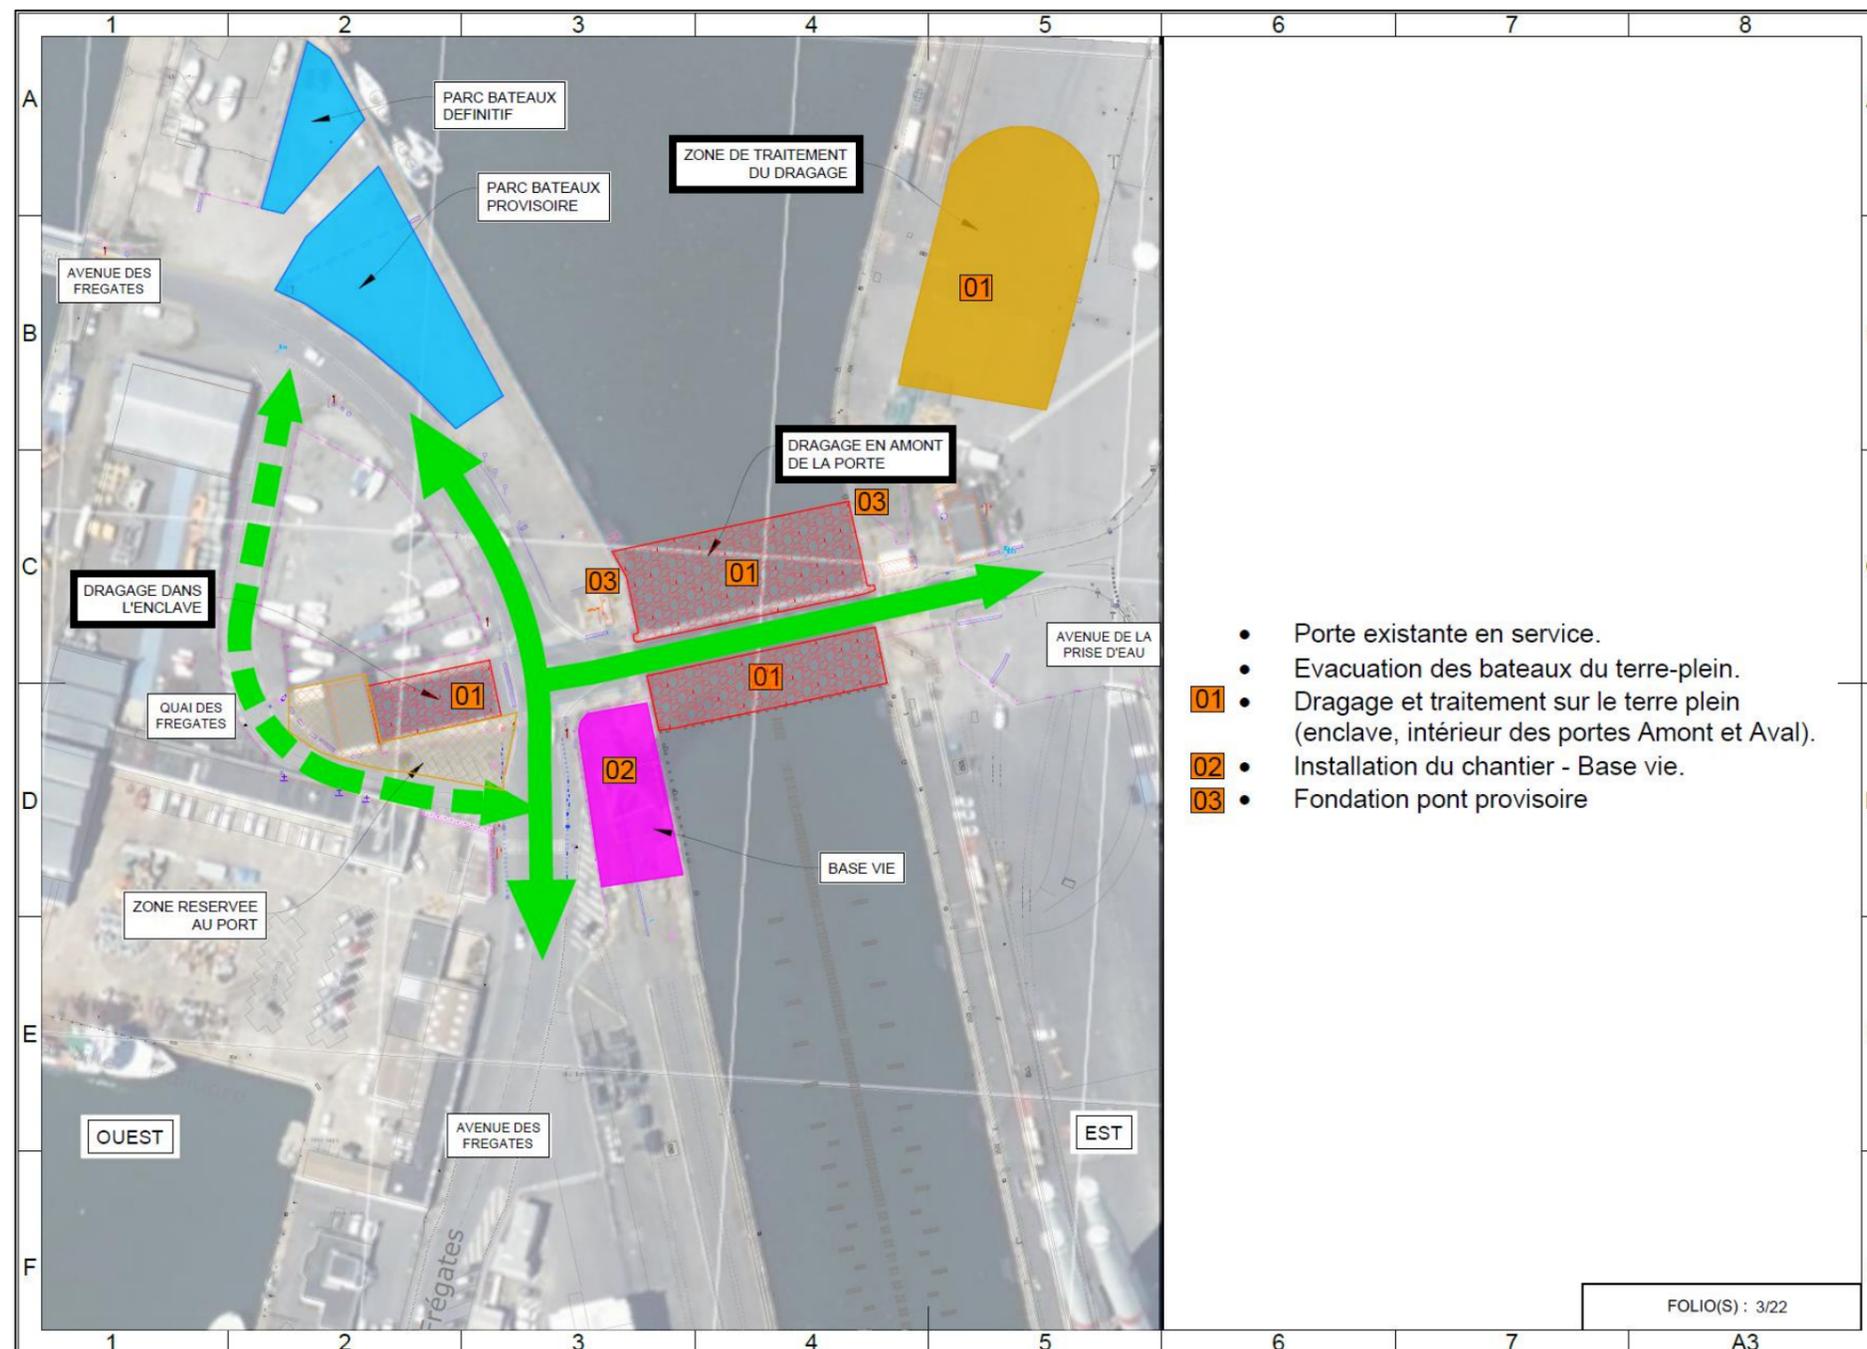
Plan du projet de dragage des sédiments (source : Groupement d'entreprises).
